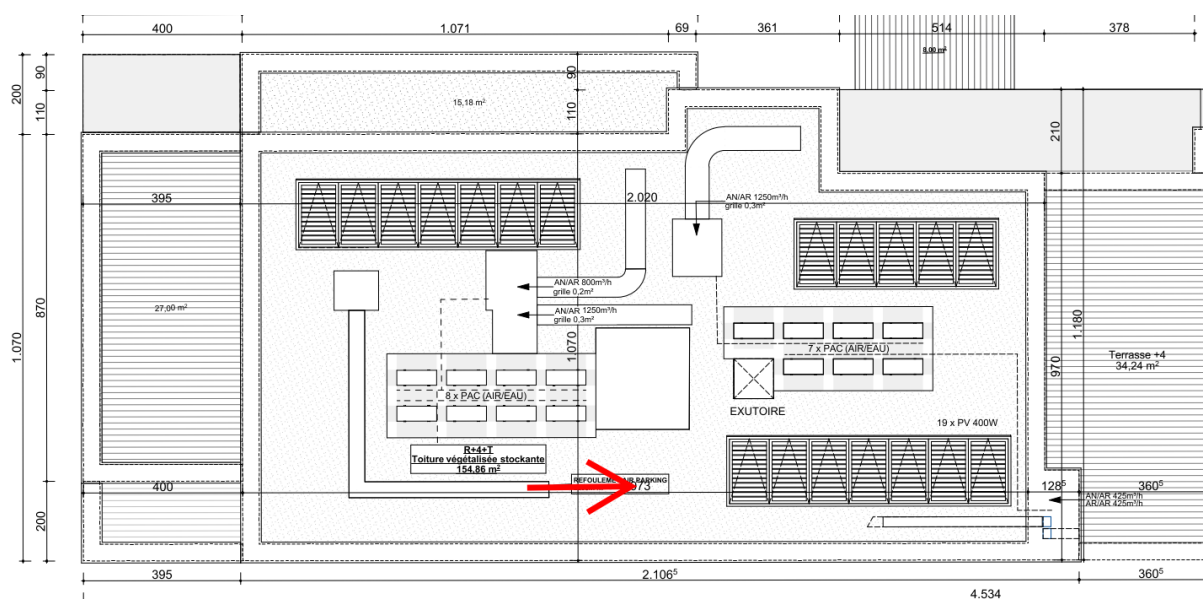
Plan de toiture du bâtiment 1 – étage +4 – rejet air vicié parking en rouge (source : Plans PU)
